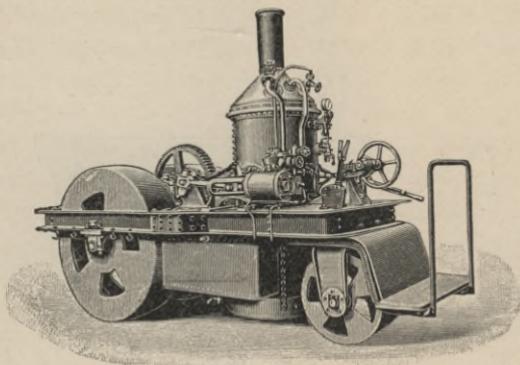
Asphaltwalze mit Dampfbetrieb.
